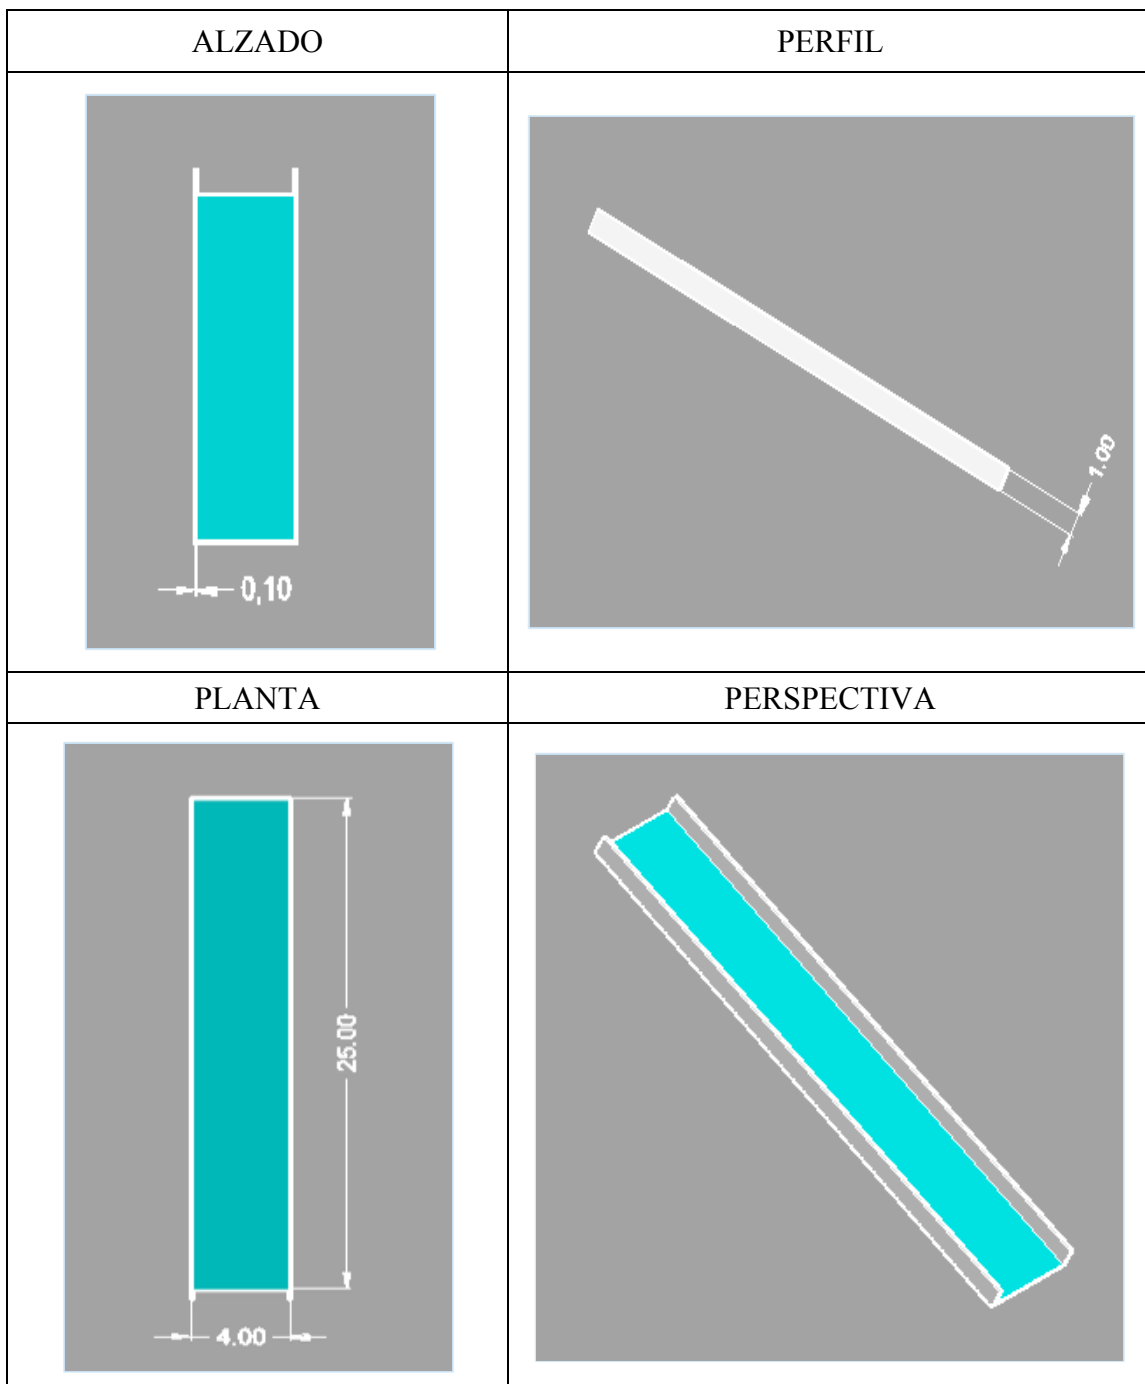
Ficha técnica (alzado, perfil, planta y vista en perspectiva dirección suroeste, en adelante, *SO*) del drenaje tradicional (alternativa A).
